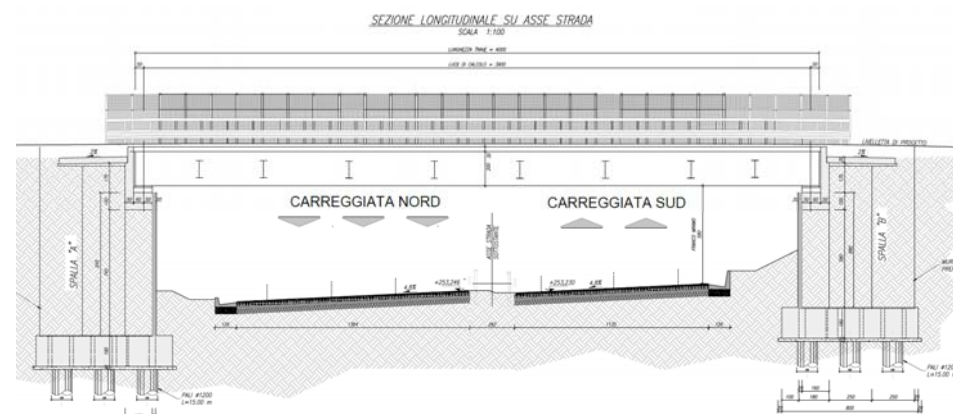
Cavalcavia Svincolo Matera Ovest: Sezione Longitudinale
